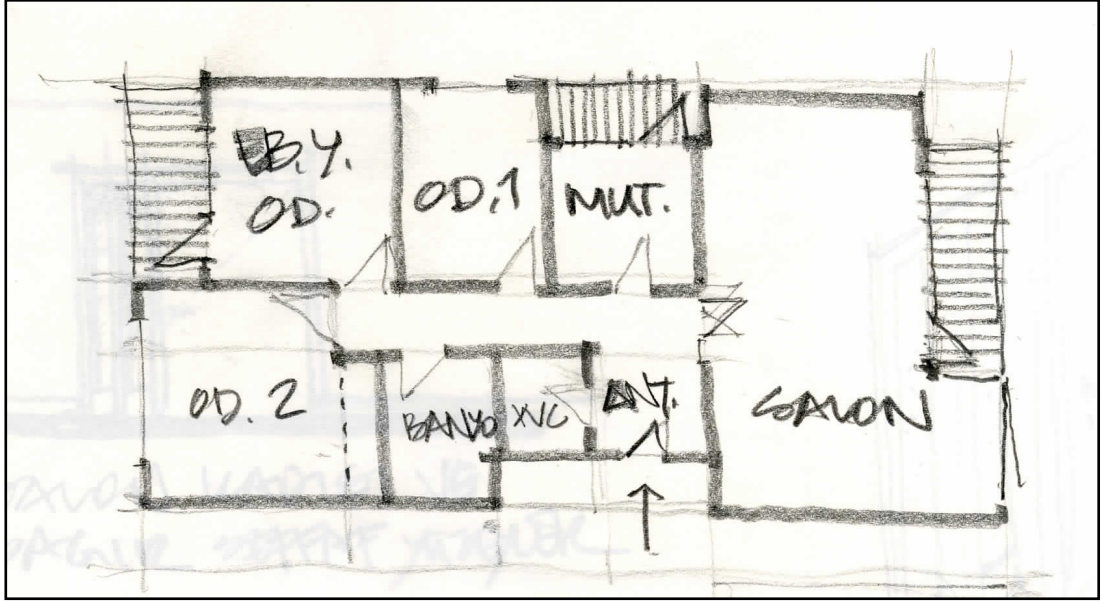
Öncüoğlu's sketch of his childhood home plan layout
